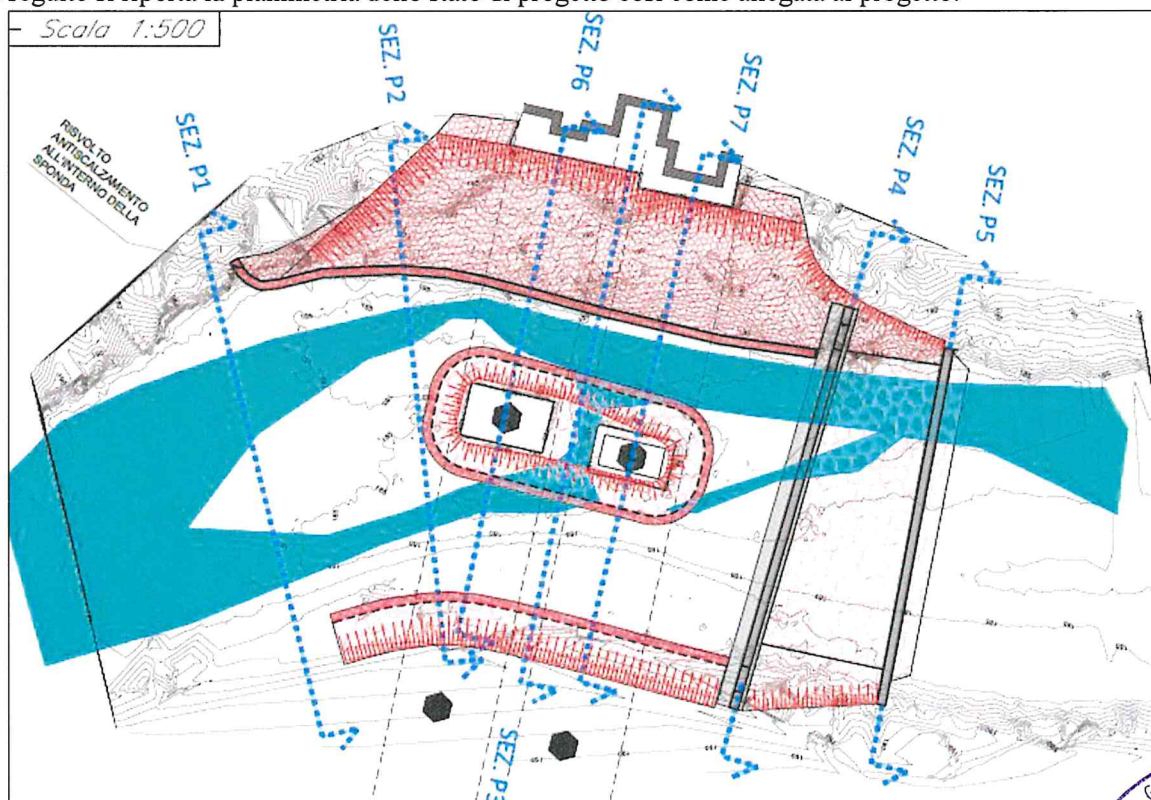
Planimetria stato di progetto (da Elab. B_03_Stato di progetto allegato allo SPA)
